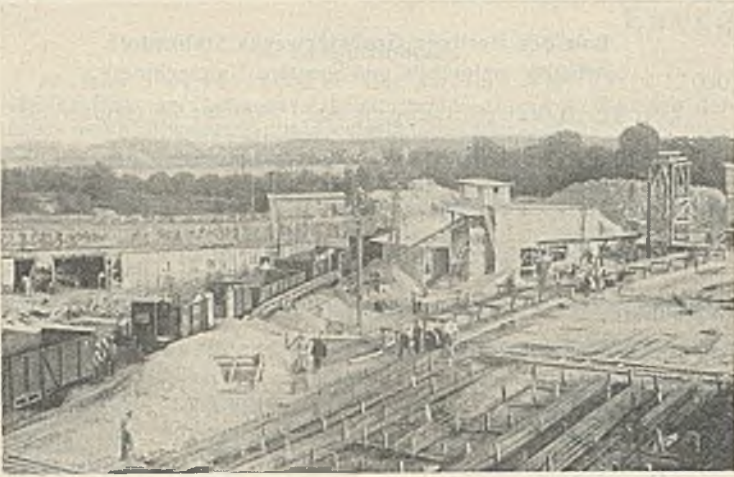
Blick auf die im Betriebe befindliche Vollbahngleisanlage.
